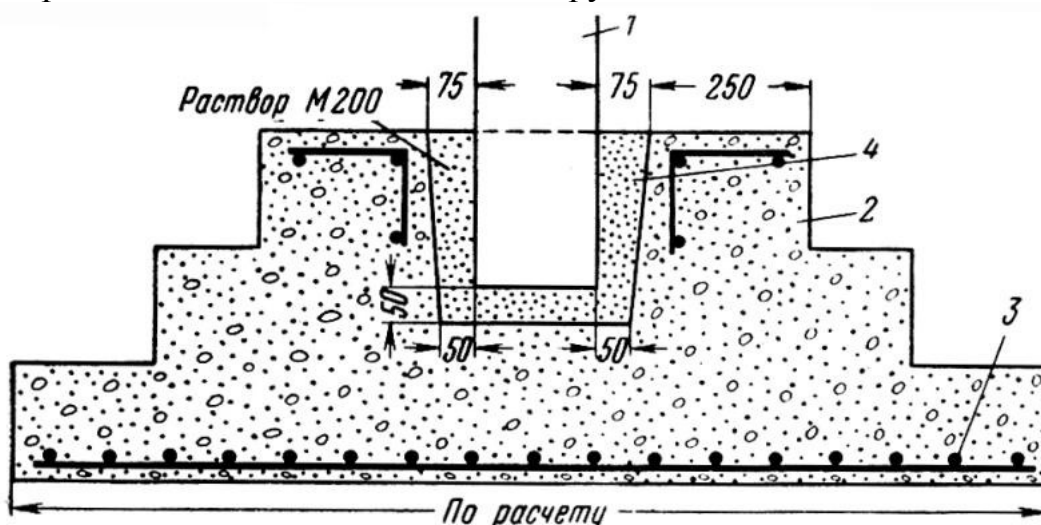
Сборный фундамент под колонну промышленного здания:
